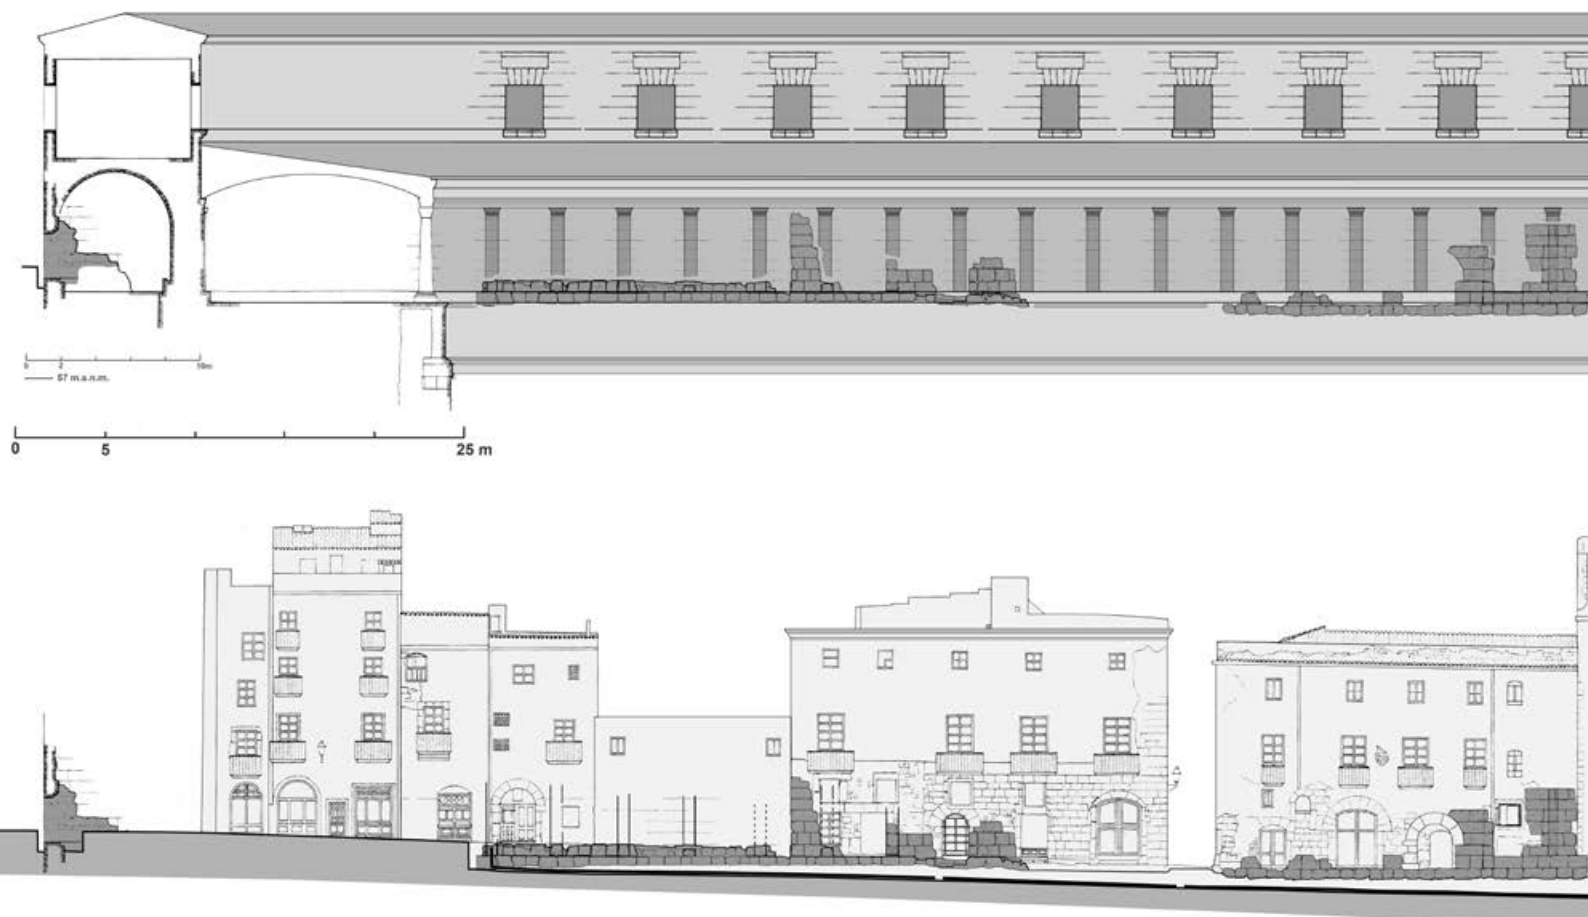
Alzado de la calle de Santa Anna con los restos romanos conservados en las fachadas de las casas modernas. Arriba. Reconstrucción de la fachada interior de la Plaza de Representación con la reconstrucción del podio corrido sobre el que se alzaban las columnatas.
